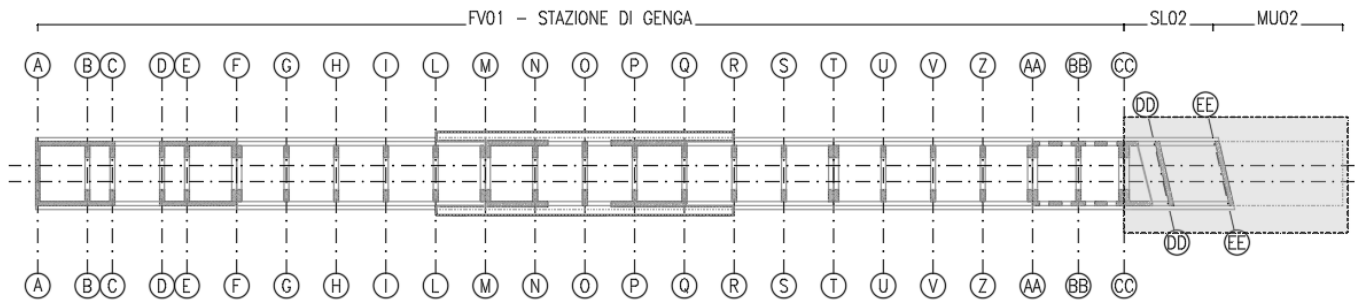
Vista planimetrica strutturale della nuova stazione di Genga e relativa suddivisione in moduli.
